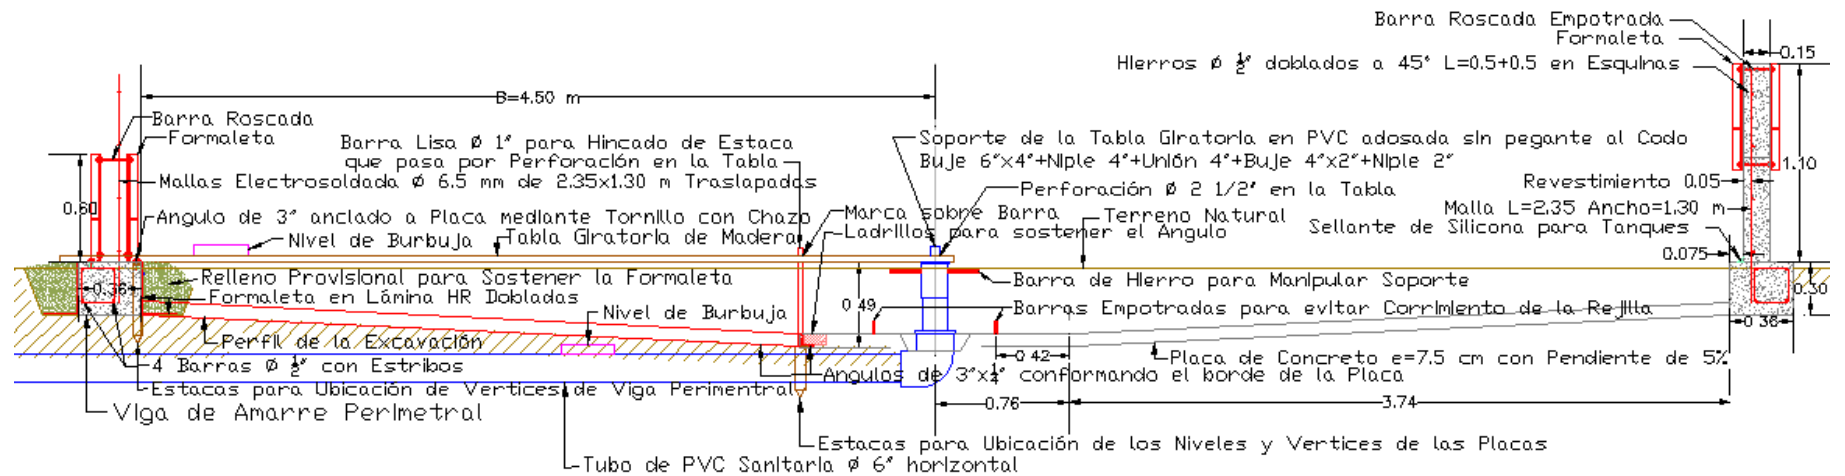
Construcción del Estanque en Concreto -Vista en Planta
